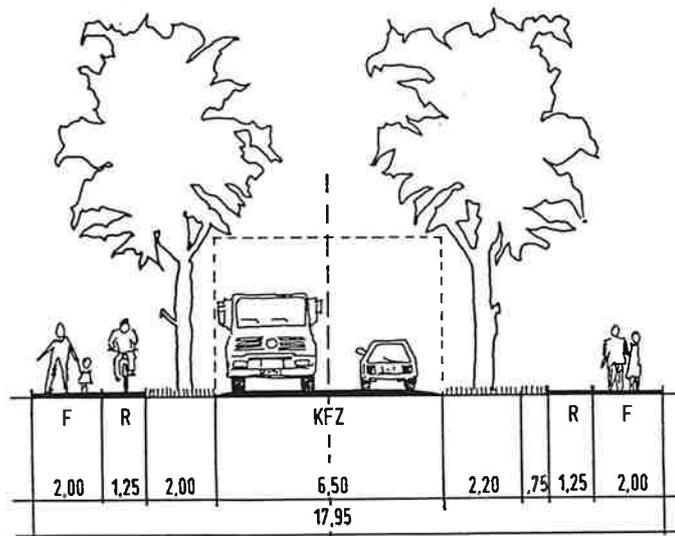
SCHNITT B-B, PLANSTRASSE A, B
